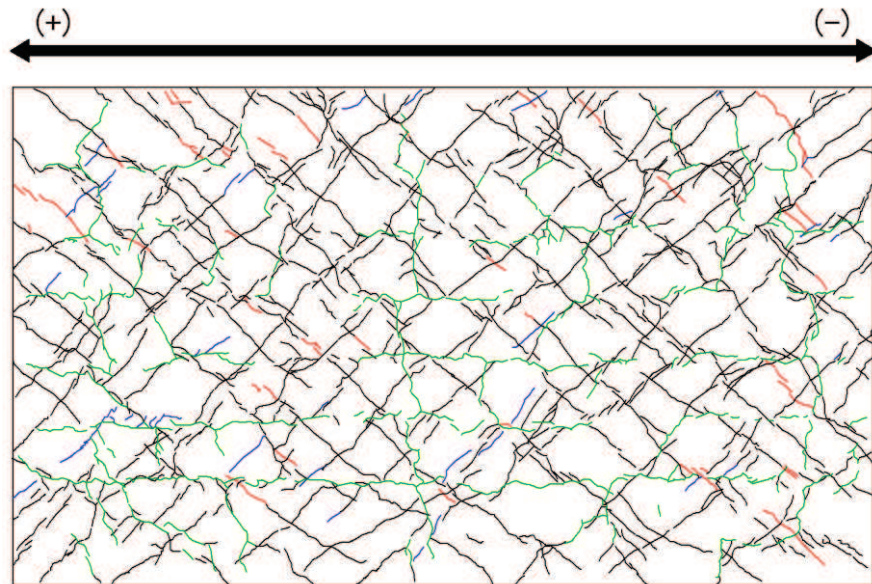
乾燥試験体 [2] 最終破壊時ひび割れ図
